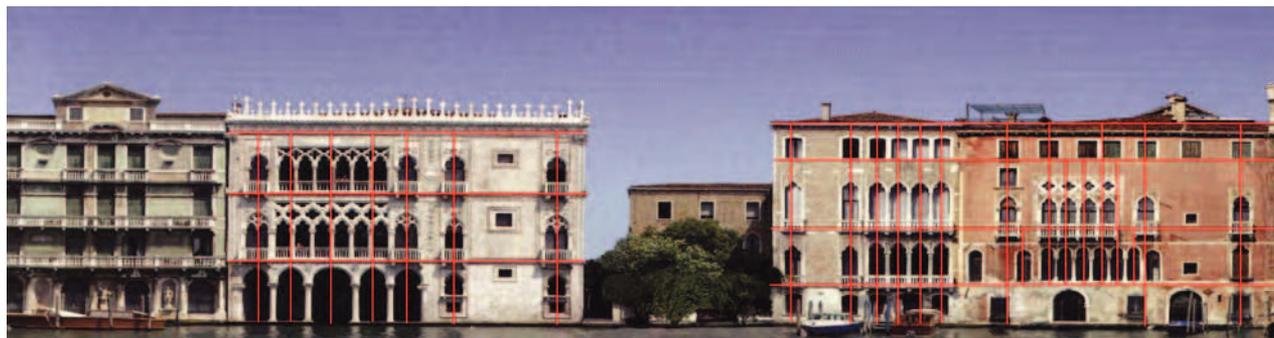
Palazzo Sagredo, prospetto sul Canal Grande.
